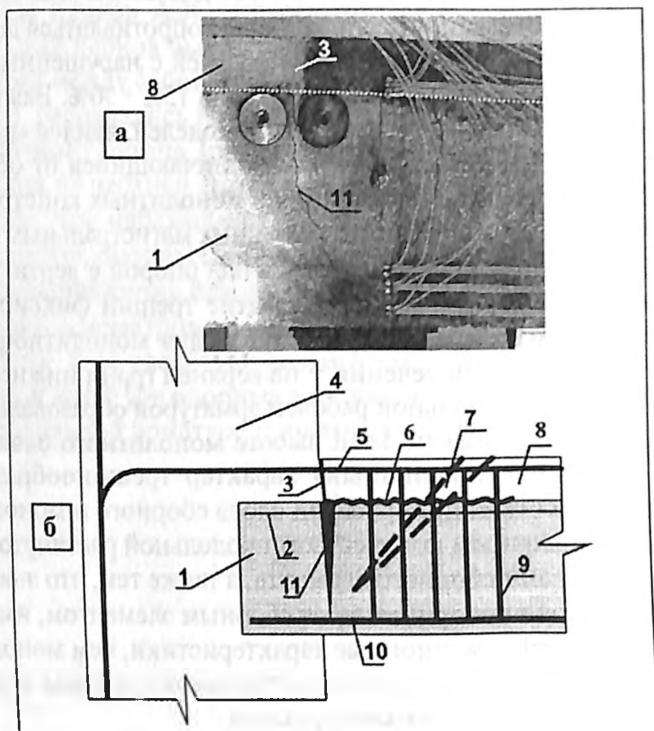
а — экспериментально выявленный характер трещинообразования; б — схема работы опорной зоны перекрытия: 1 — сборный железобетон; 2 — конструктивная арматура верх сборного элемента; 3 — микротрещина ( $<0.05\text{мм}$ ); 4 — железобетонная стена; 5 — растянутая продольная рабочая арматура; 6 — трещина расслоения; 7 — наклонная трещина по СНиП; 8 — монолитный железобетон; 9 — поперечная арматура 10 — сжатая продольная рабочая арматура; 11 — трещина разрушения
